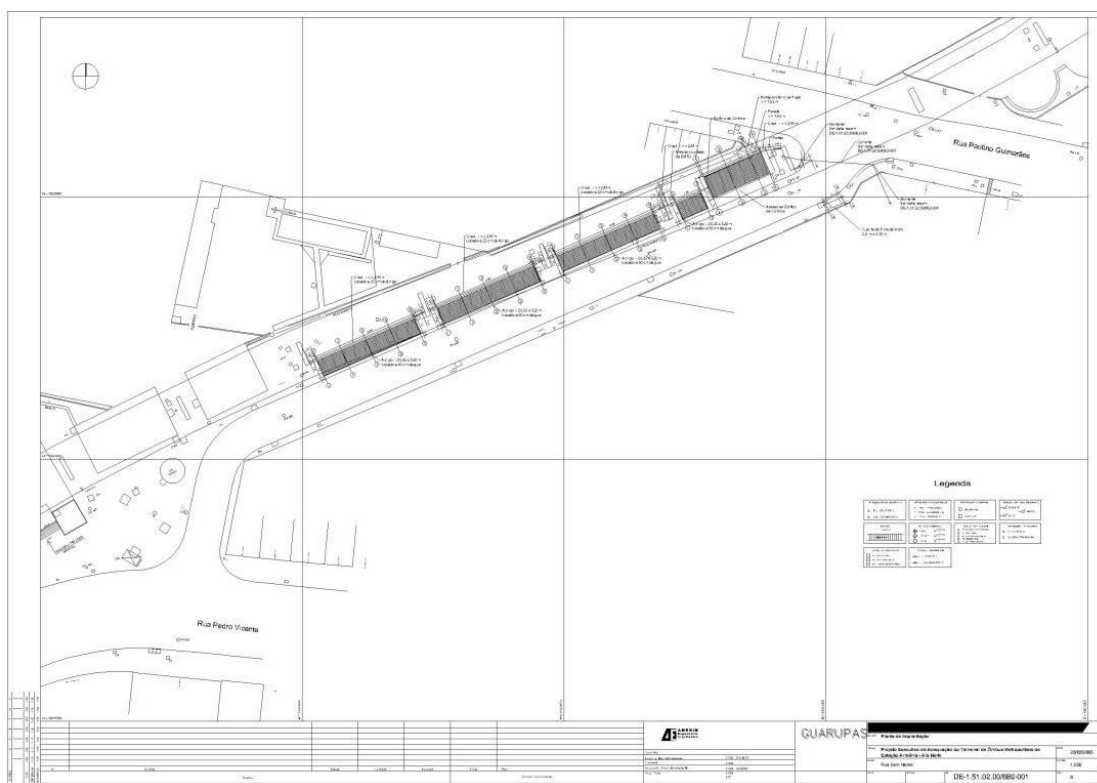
Planta Terminal Metropolitano Armênia Norte
